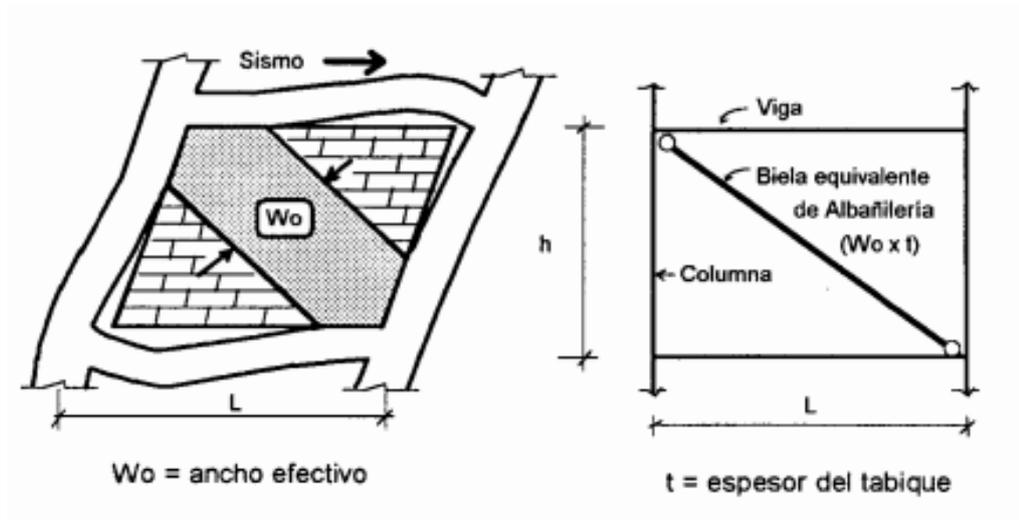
Modelaje de tabiques de albañilería (San Bartolomé, 1994, p.15)
